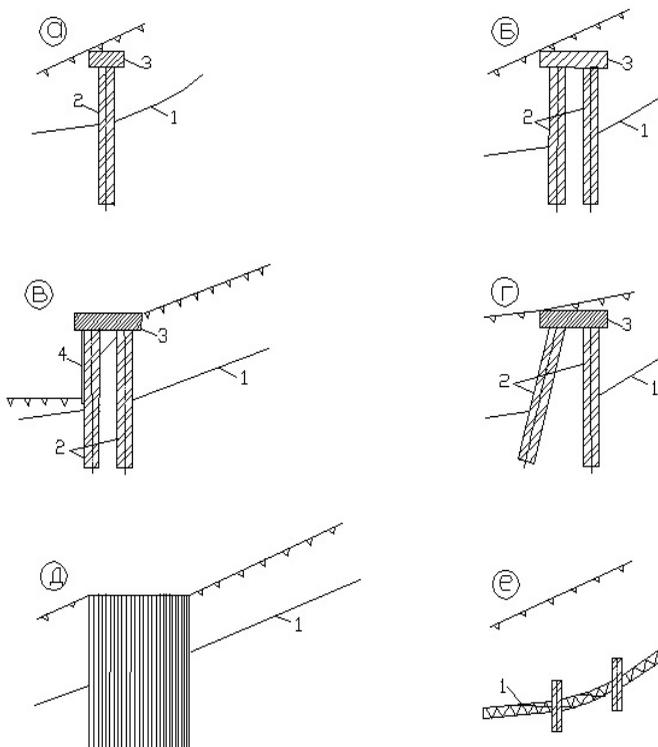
Свайные конструкции (СП 436.1325800.2018):
